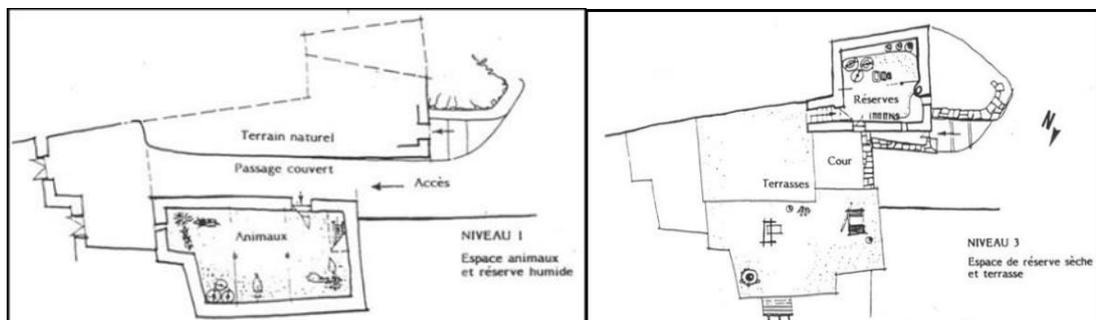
Plan du 1^{er} et 2^{eme} niveau d'une maison Chaoui [14].
